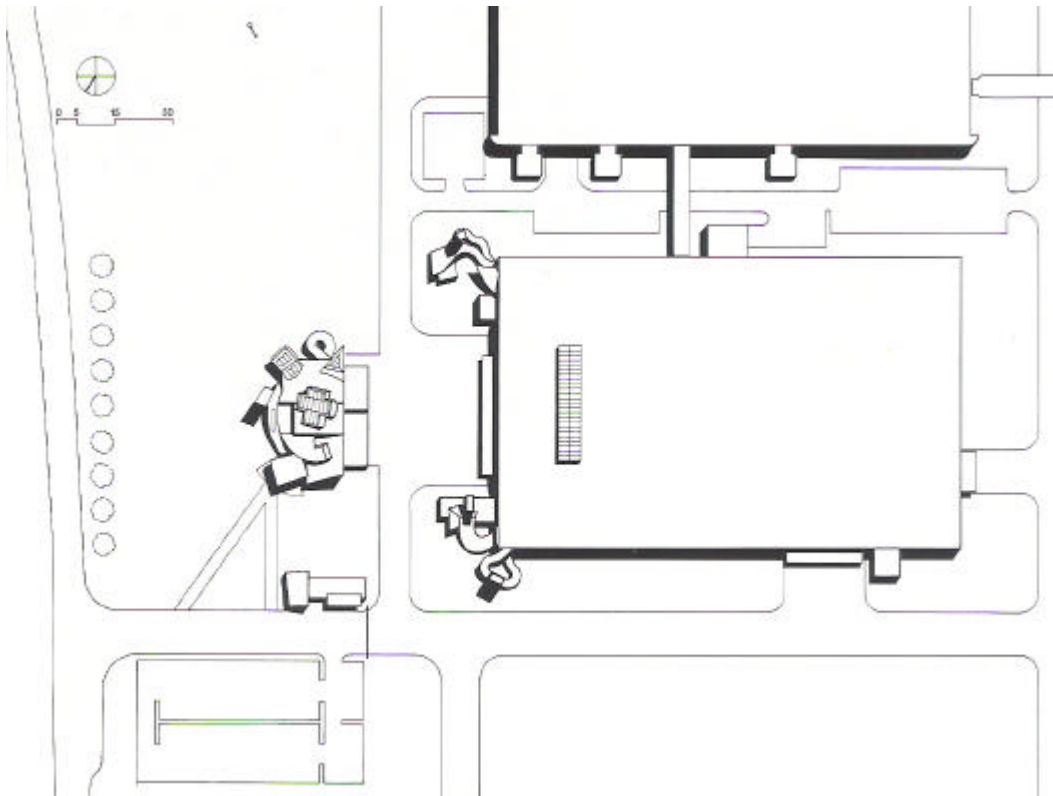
Frank Gehry, Fabrikationshalle, Museum und Pförtnerhaus, 1987-1989, Lageplan
